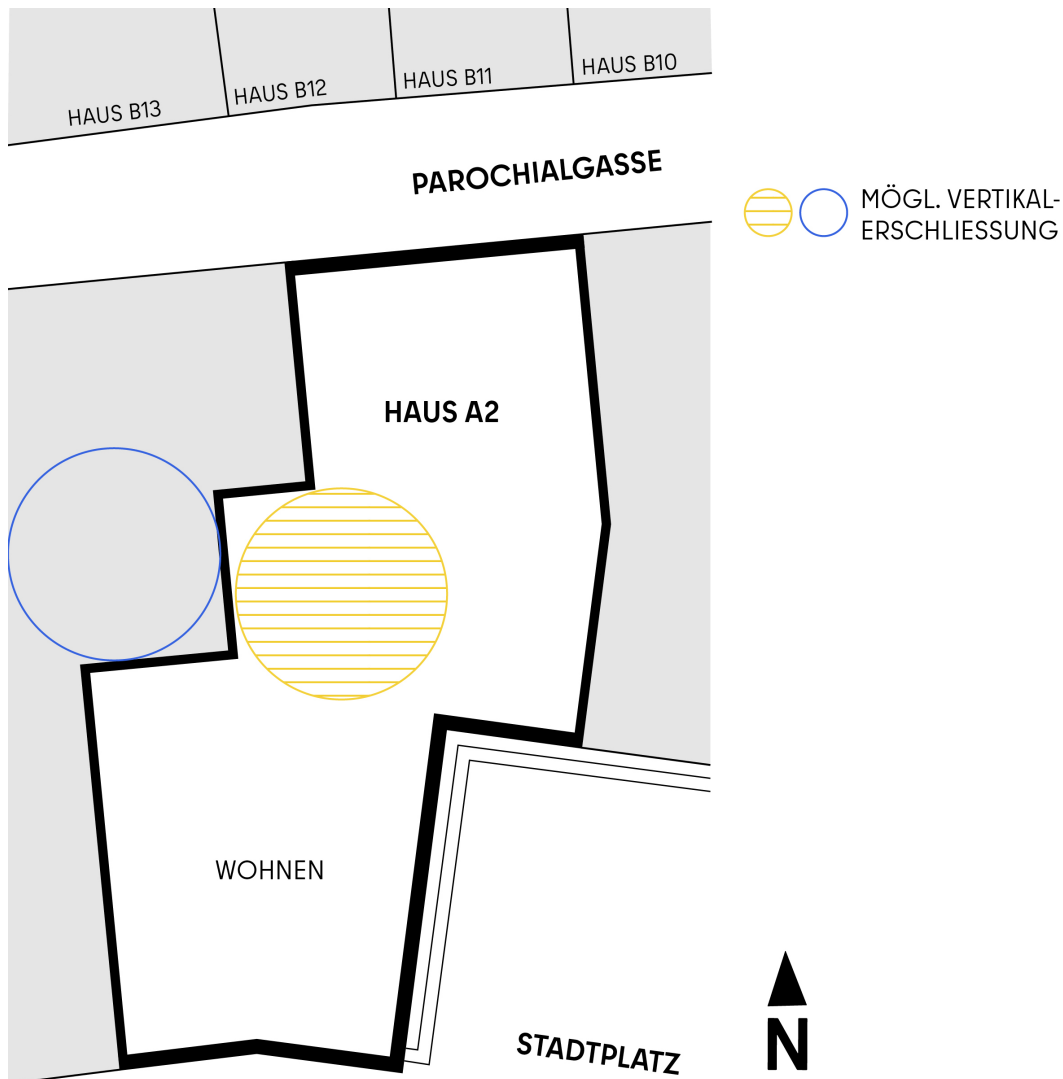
Schematischer Grundriss Regelgeschoss
